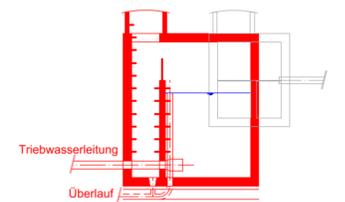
Grundriss und Schnitt der Anpassungen an der Brunnenstube
